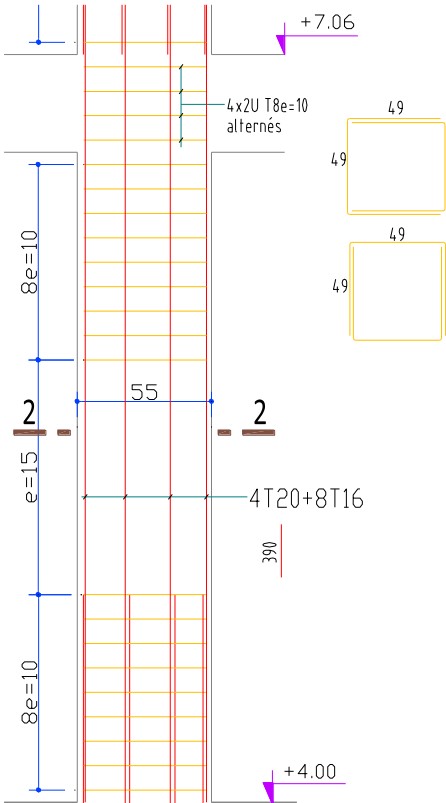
Coupe verticale de ferrailage des poteaux 55 x 55 cm².
